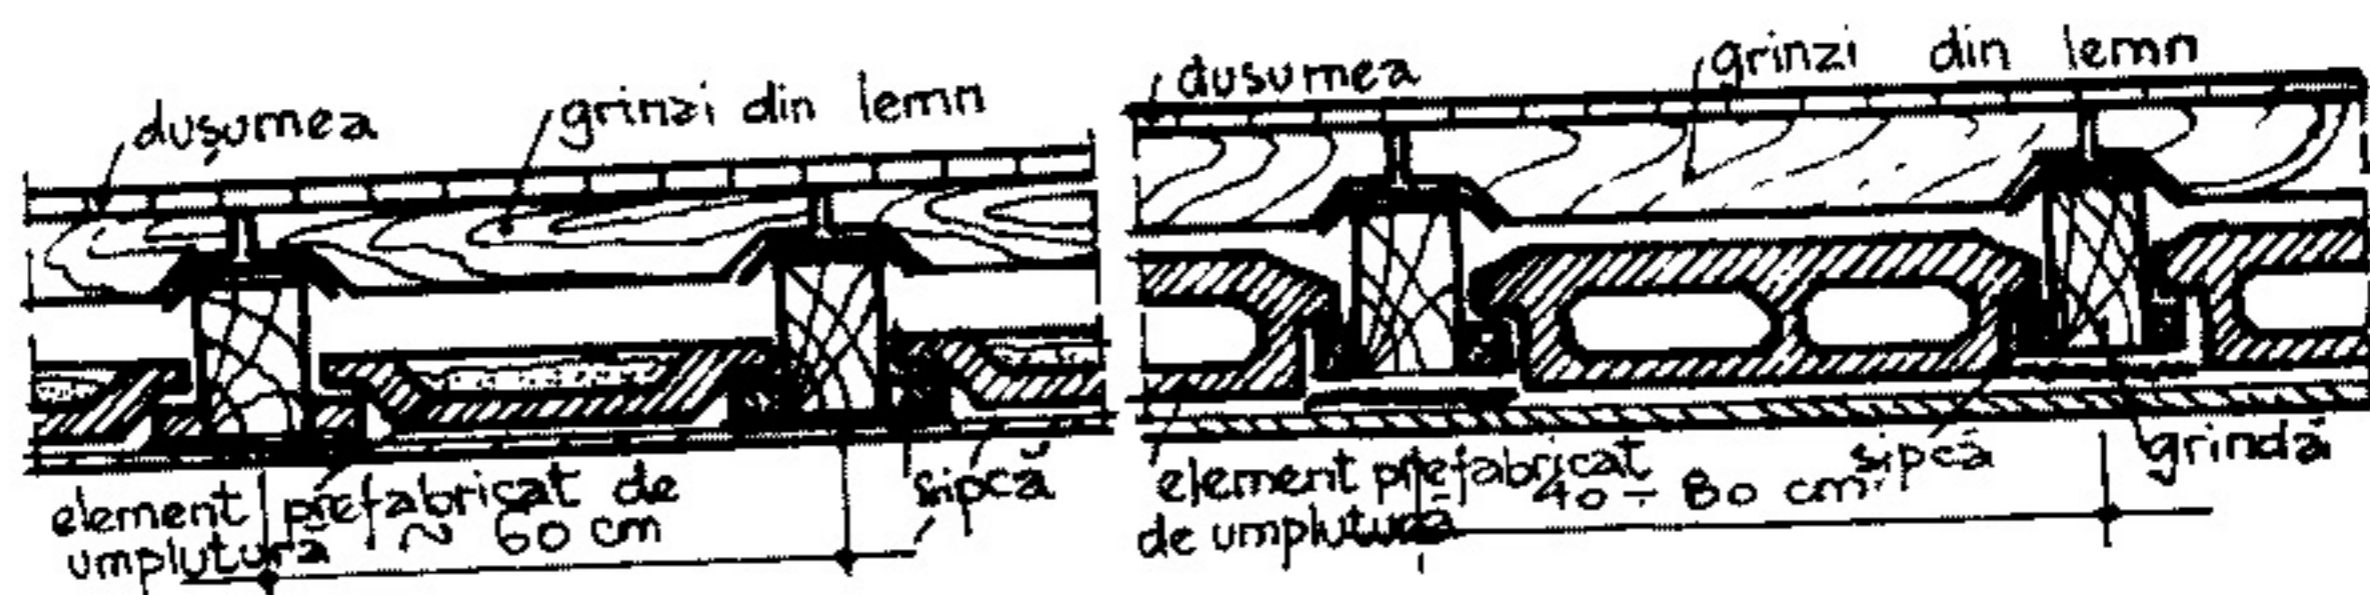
Planșeu din lemn cu umplutură din elemente prefabricate
